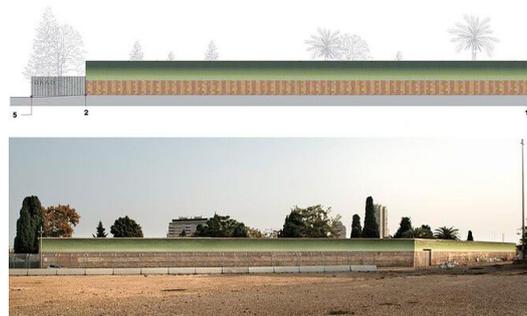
Vista general del muro intervenido. Fuente: (Navarro, 2016)
